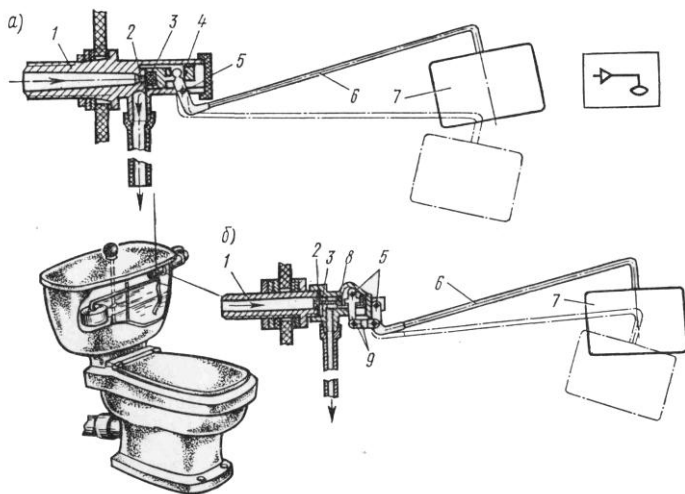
Конструкции поплавковых клапанов [11]:
